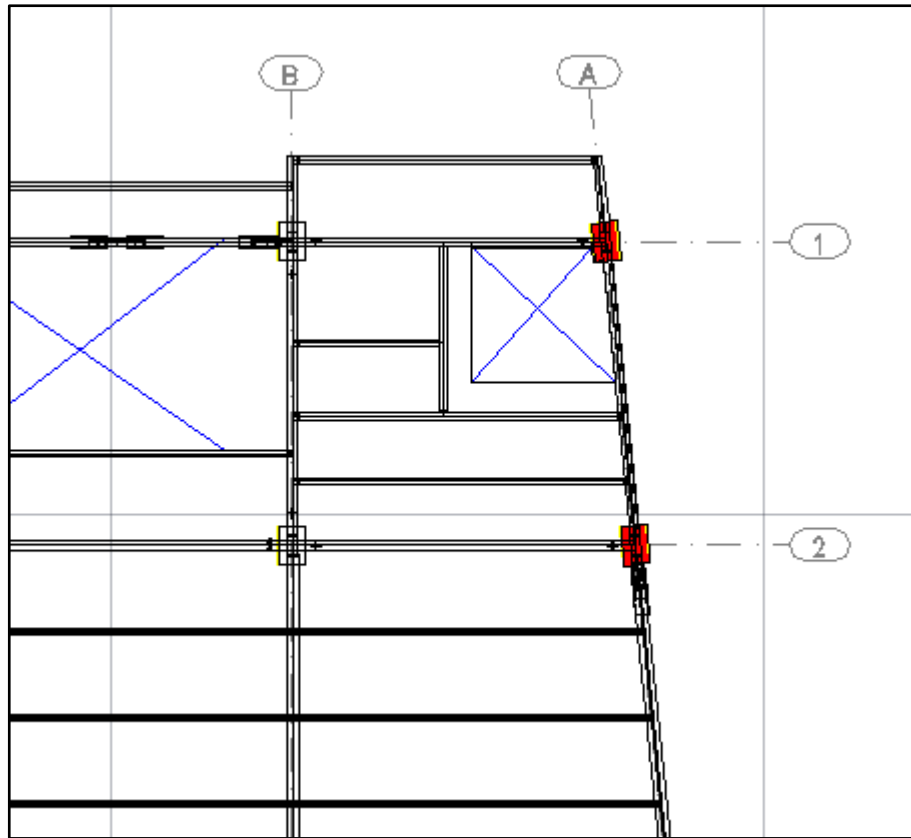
Localización de columnas tipo C7 y C8. Fuente: tomada por el pasante.
